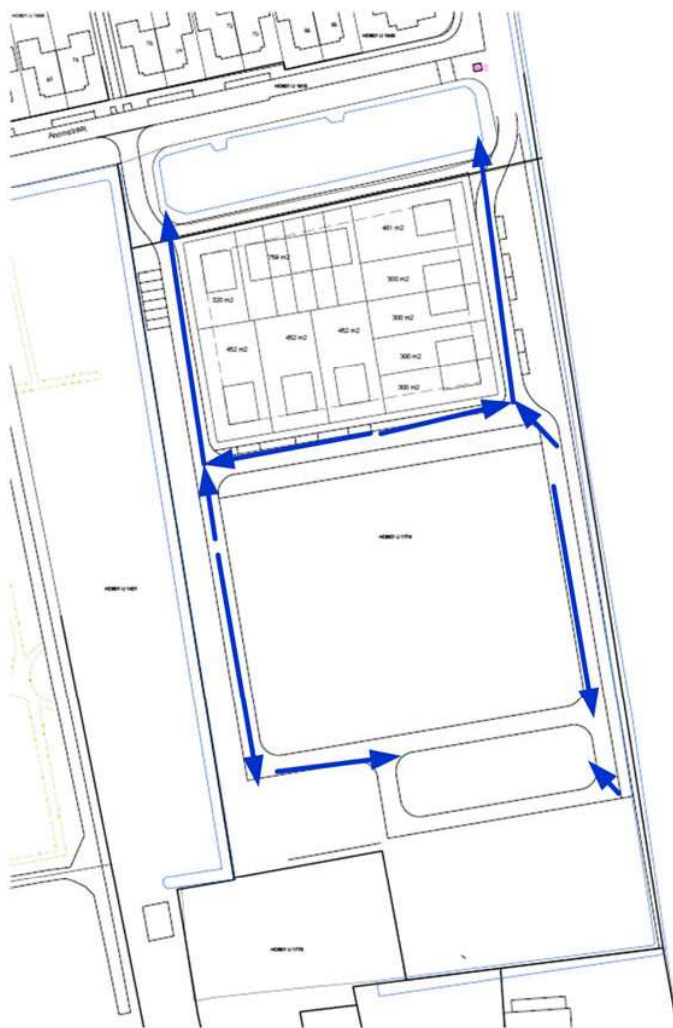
Stedenbouwkundig plan, 1 december 2020, gemeente Hardenberg
